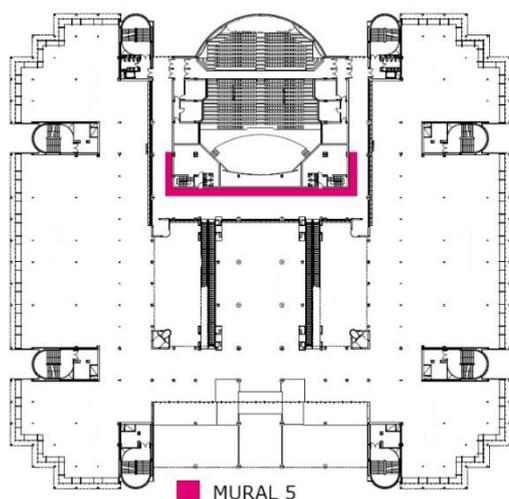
Plano entreplanta 1 donde se ubica el mural 5..
